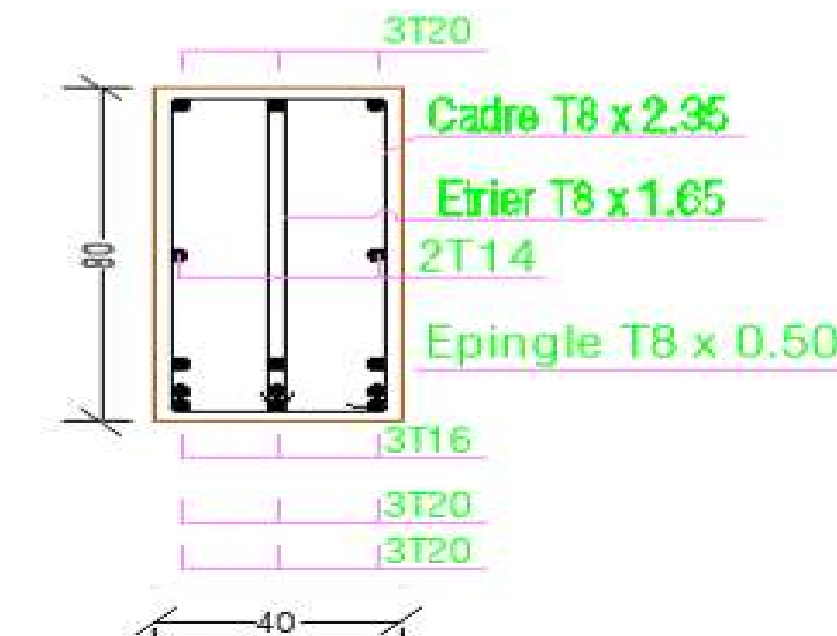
Disposition constructive des armatures des poutres en travée
